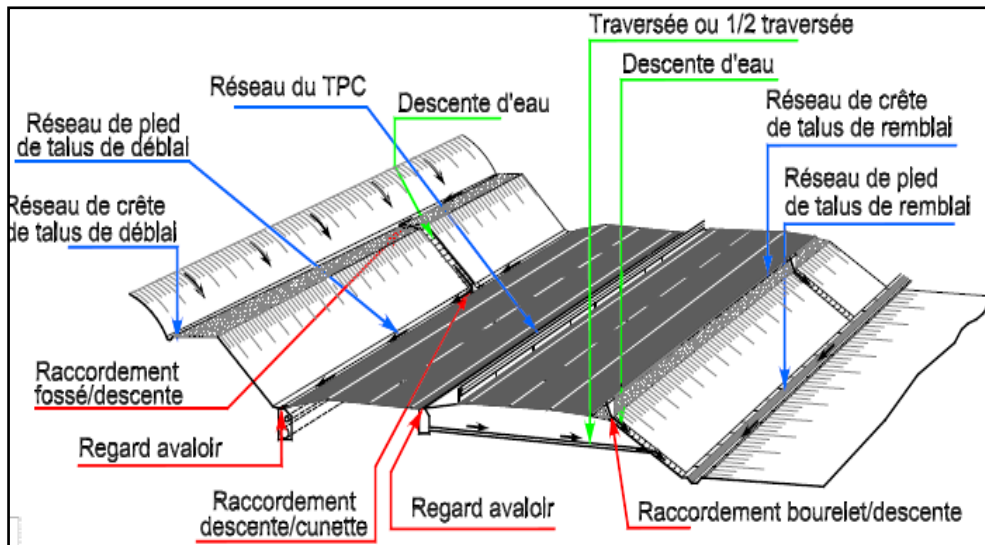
1:Situation des réseaux d'assainissement sur le profil en travers d'une route.
